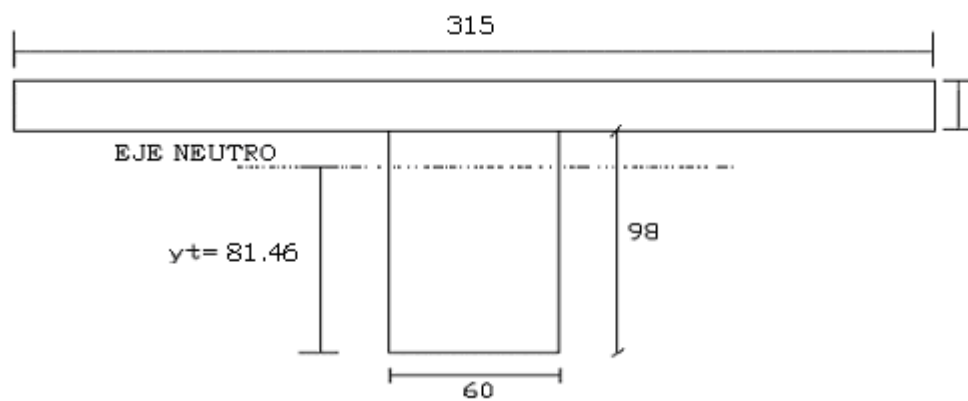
Sección no fisurada de la viga exterior. Dimensiones en (cm).
